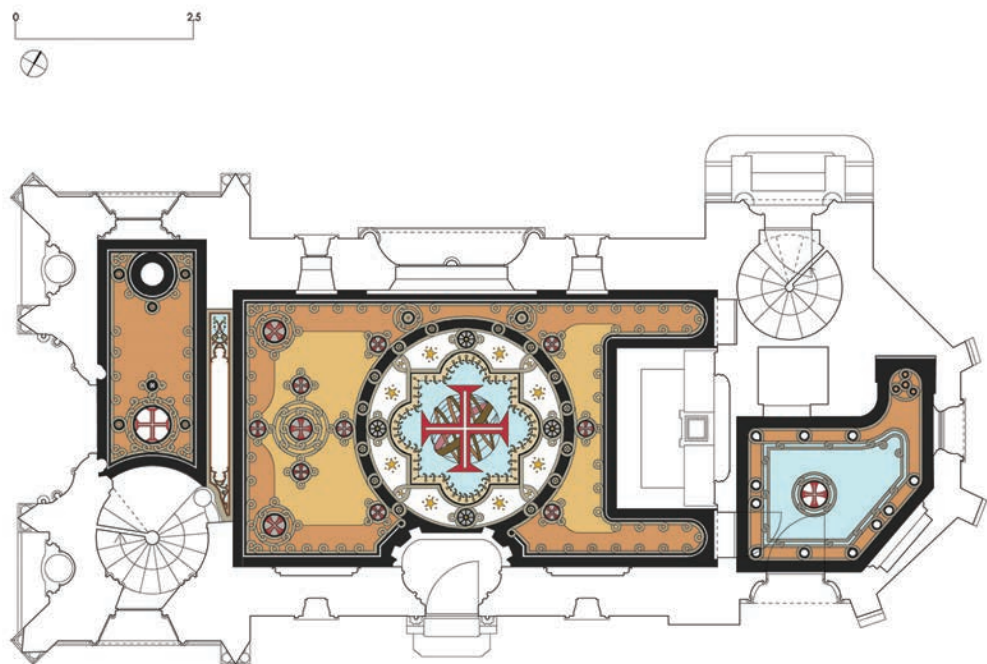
La Quinta da Regaleira a Sintra, a Capela, pianta cromatica della pavimentazione.
